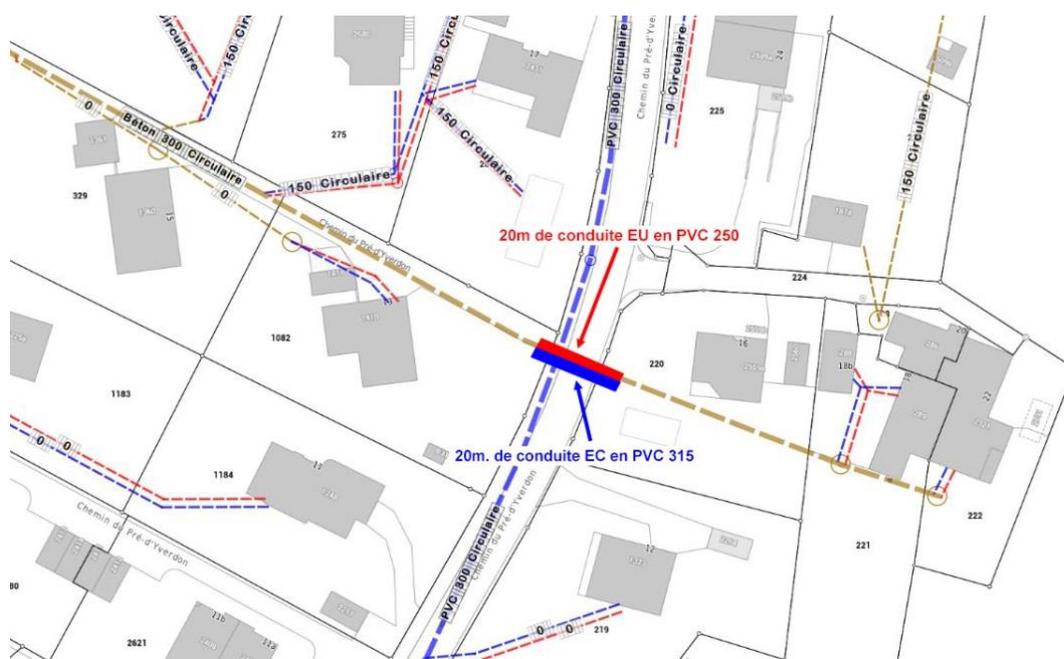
Plan des travaux sur le Ch. du Pré d'Yverdon
